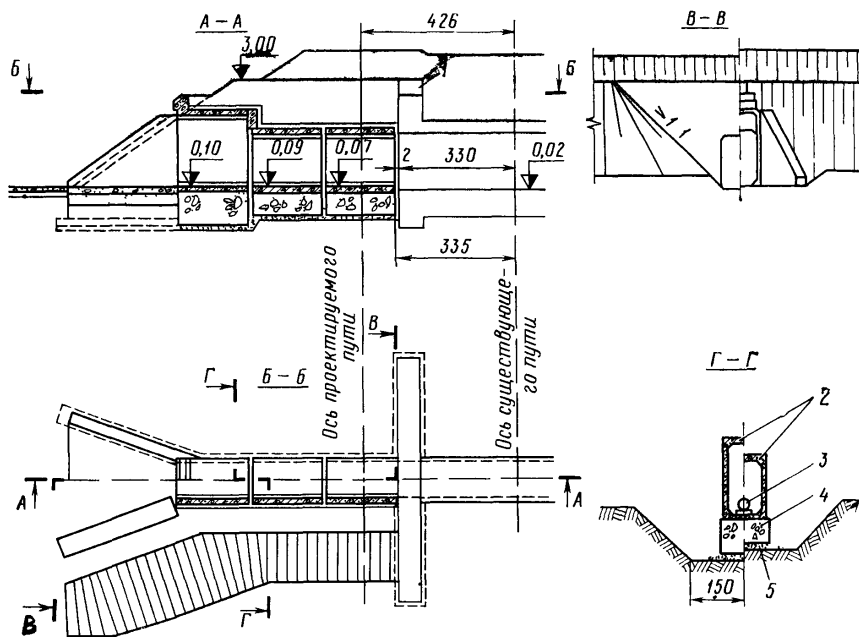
Удлинение прямоугольной трубы с порталными оголовками (размеры в сантиметрах): 1 – разбираемая часть оголовка; 2 – железобетонные звенья; 3 – металлическая труба для пропуска воды через место производства работ; 4 – бетонные фундаменты; 5 – щебеночная подготовка
